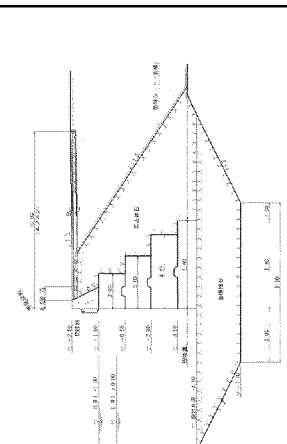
コンクリート方塊重力式構造の比較断面図
